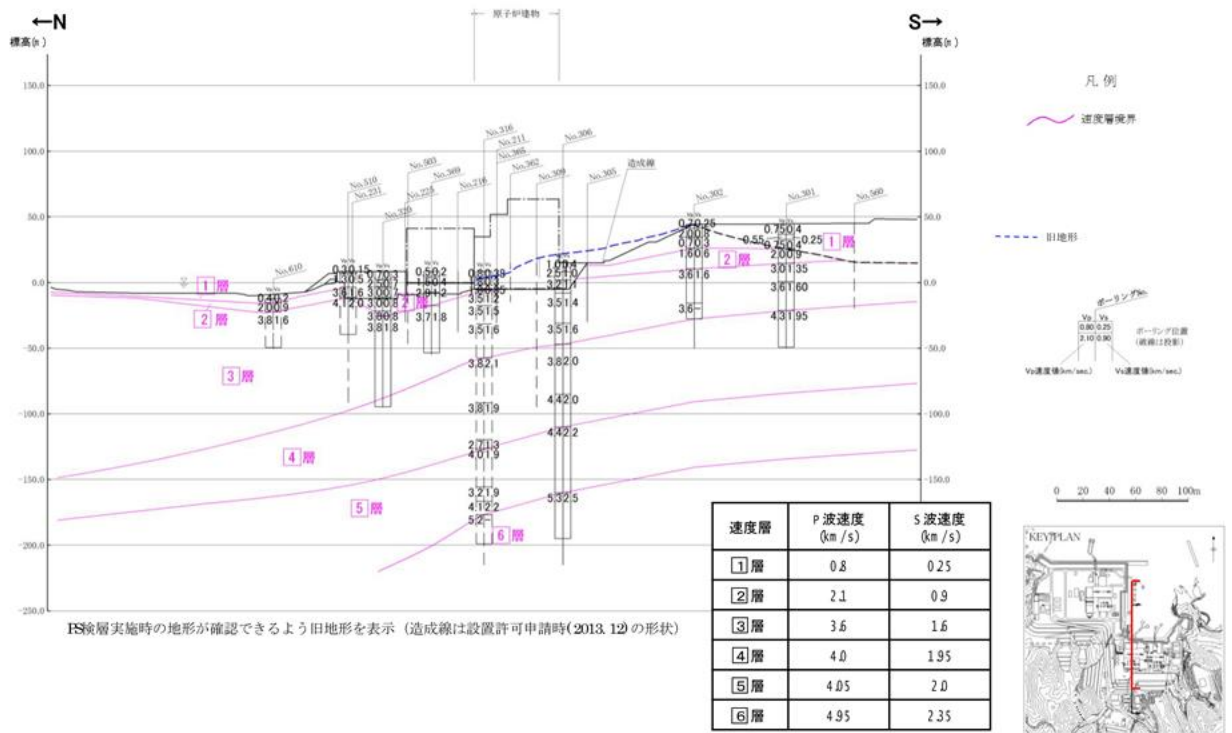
原子炉建物基礎地盤の速度層断面図 (南北断面)
